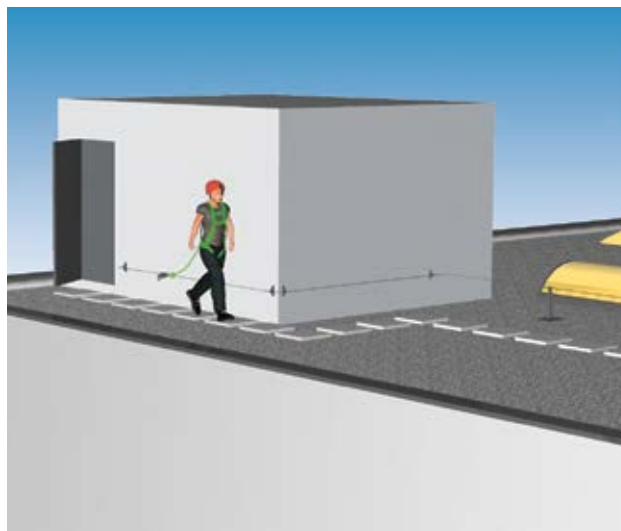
accesso sicuro su lavori un tetto piano per lavori di breve durata
